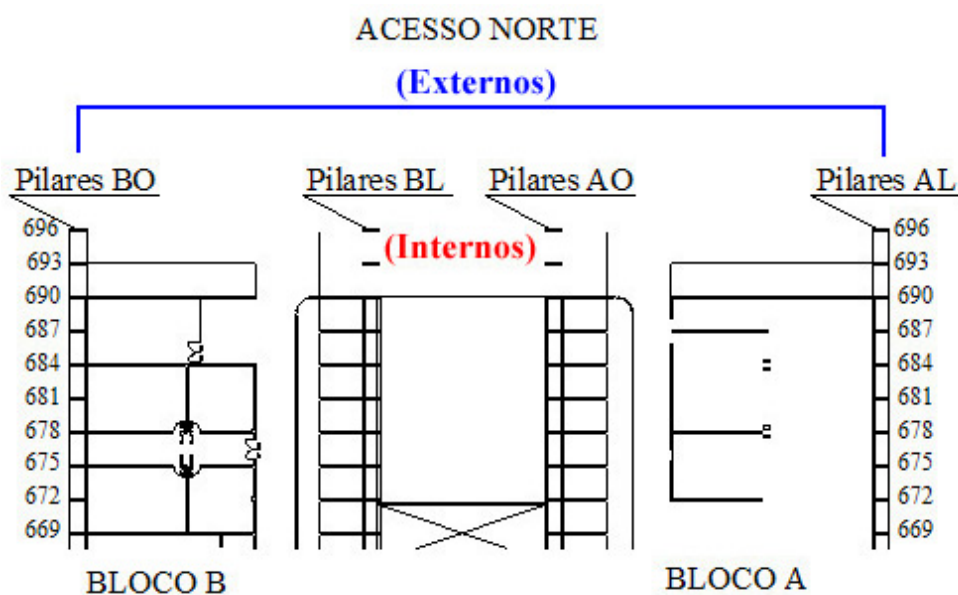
Nomenclatura dos Pilares vistos em planta – extremo norte. (Andrade, 2006)
